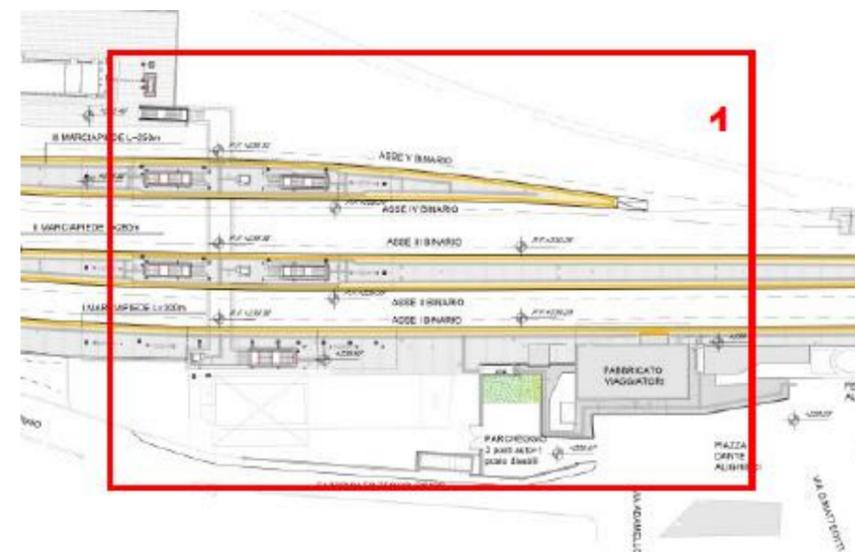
Planimetria di progetto della Stazione di Porta San Pietro
